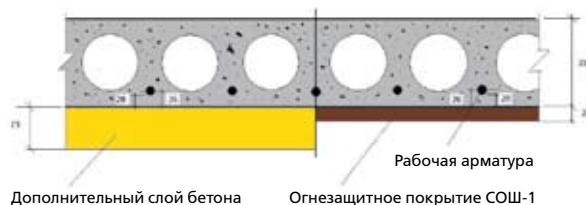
Способы огнезащиты железобетонных конструкций (R 180).
